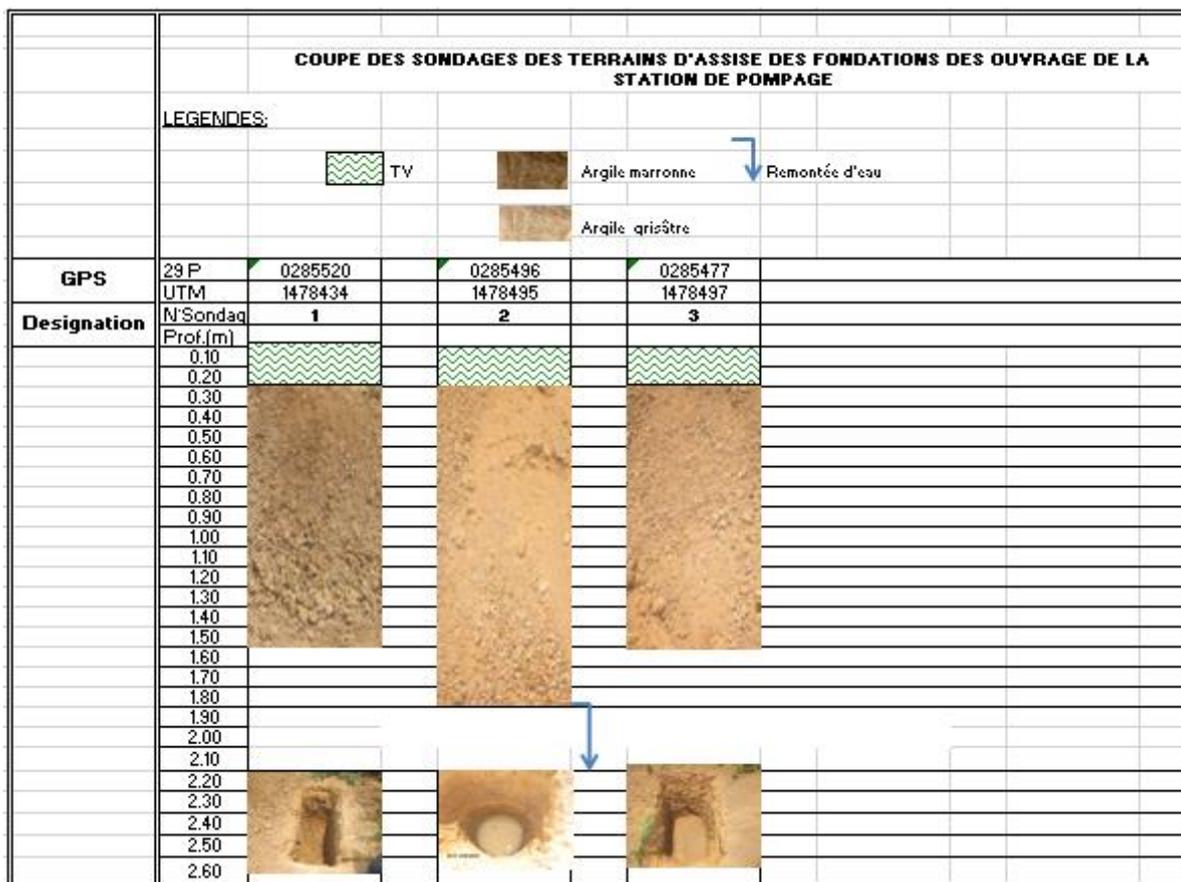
Coupe des sondages des terrains d’assise des fondations de la SP
